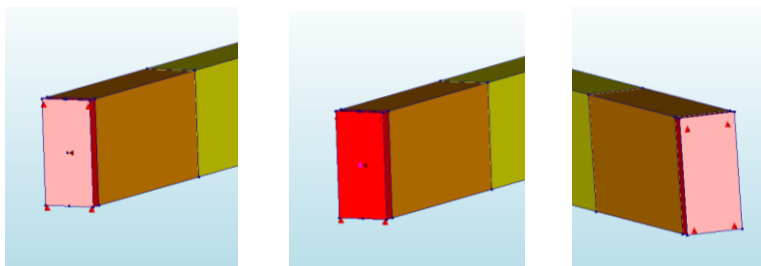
Condiciones de apoyo en viga. Izq: Restricción eje Z (Área), Med: Restricción eje Y (Punto), Der: Restricción eje Z (Área).
